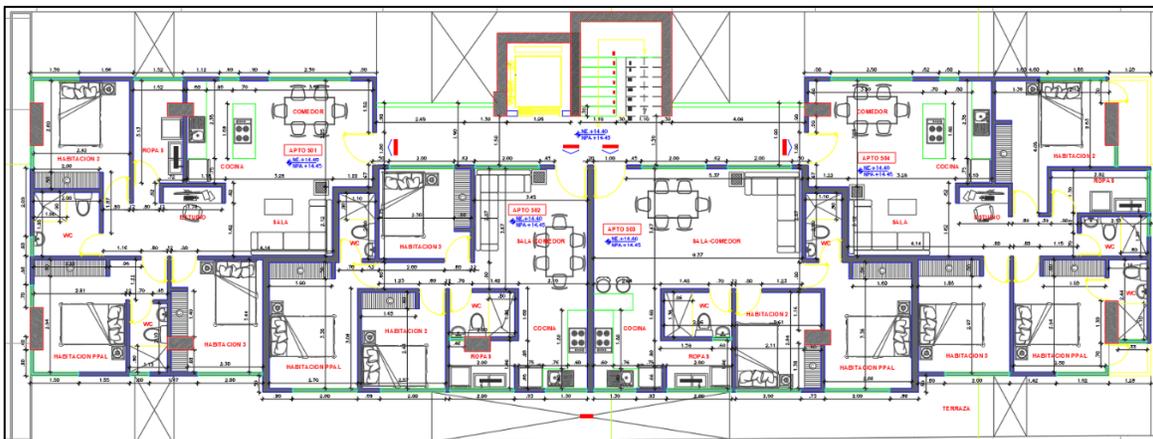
Planta arquitectónica pisos 6 a 12 (fuente: Planos arquitectónicos Arq. Mario Huertas)
